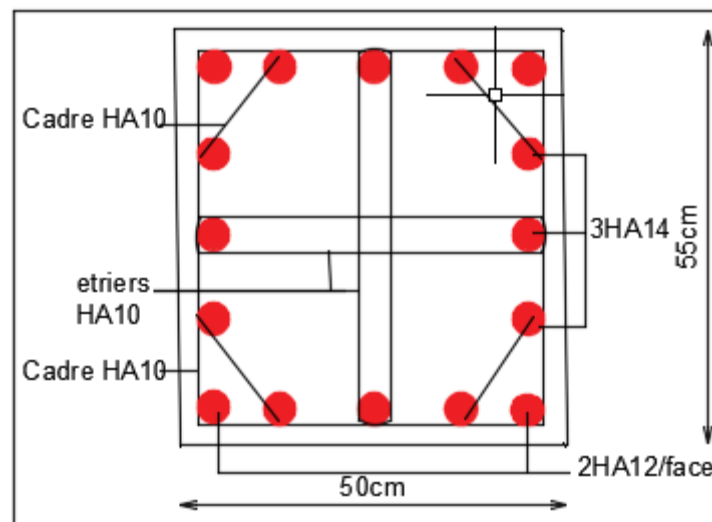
Schéma de ferrailage des poteaux 5eme, -6me et 7eme étage
